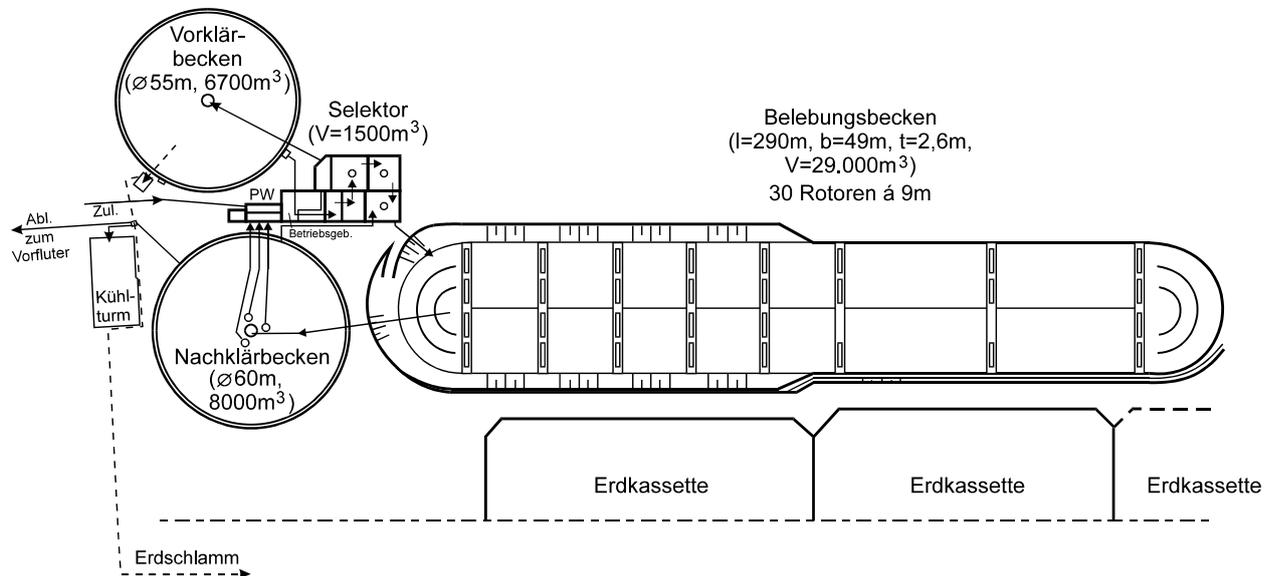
Lageplan Abwasserreinigungsanlage Fabrik B
